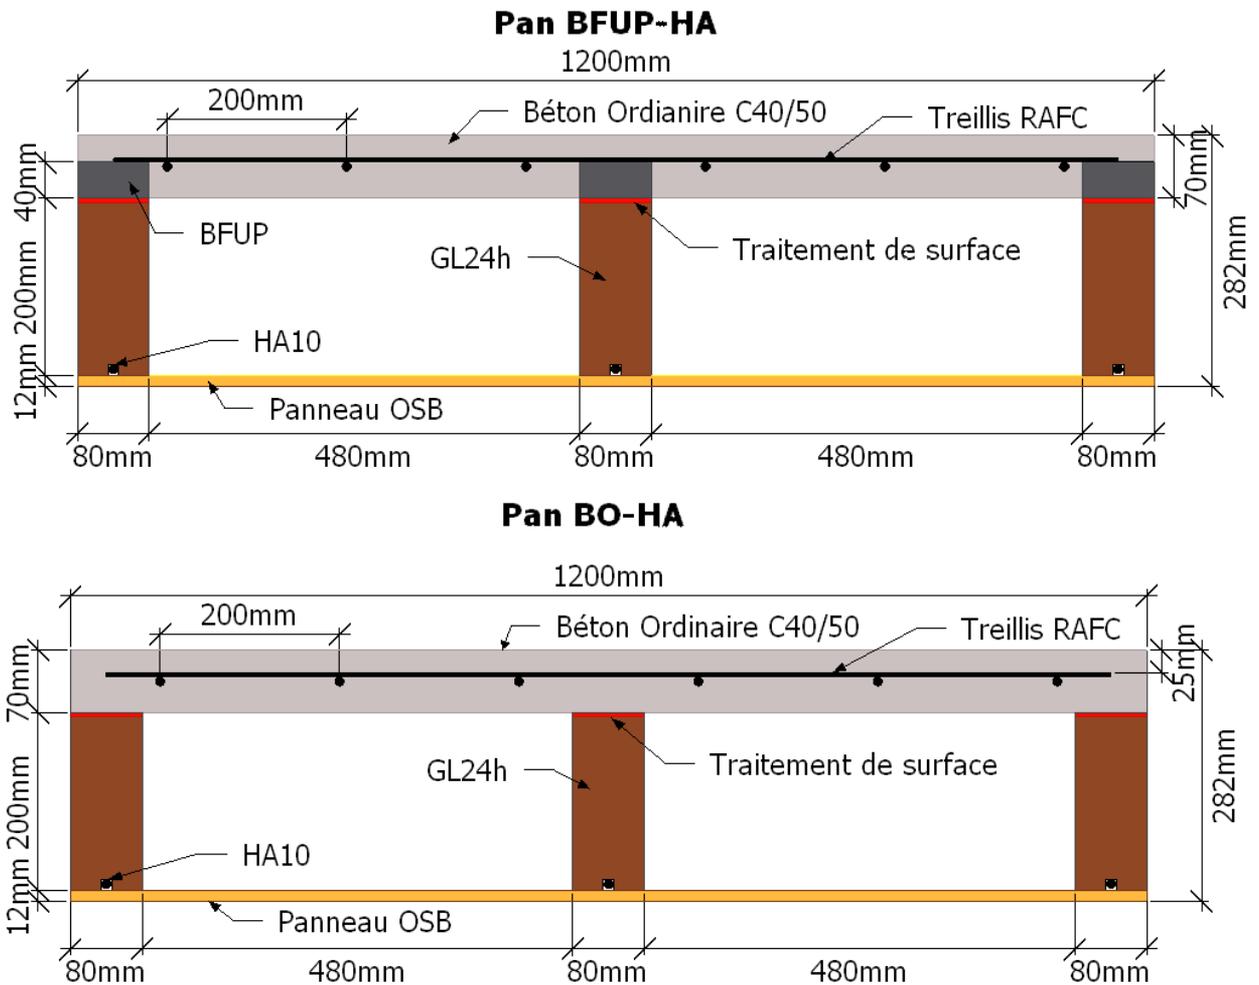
Section des planchers hybrides : BFUP-HA (haut) et BO-HA (bas)
